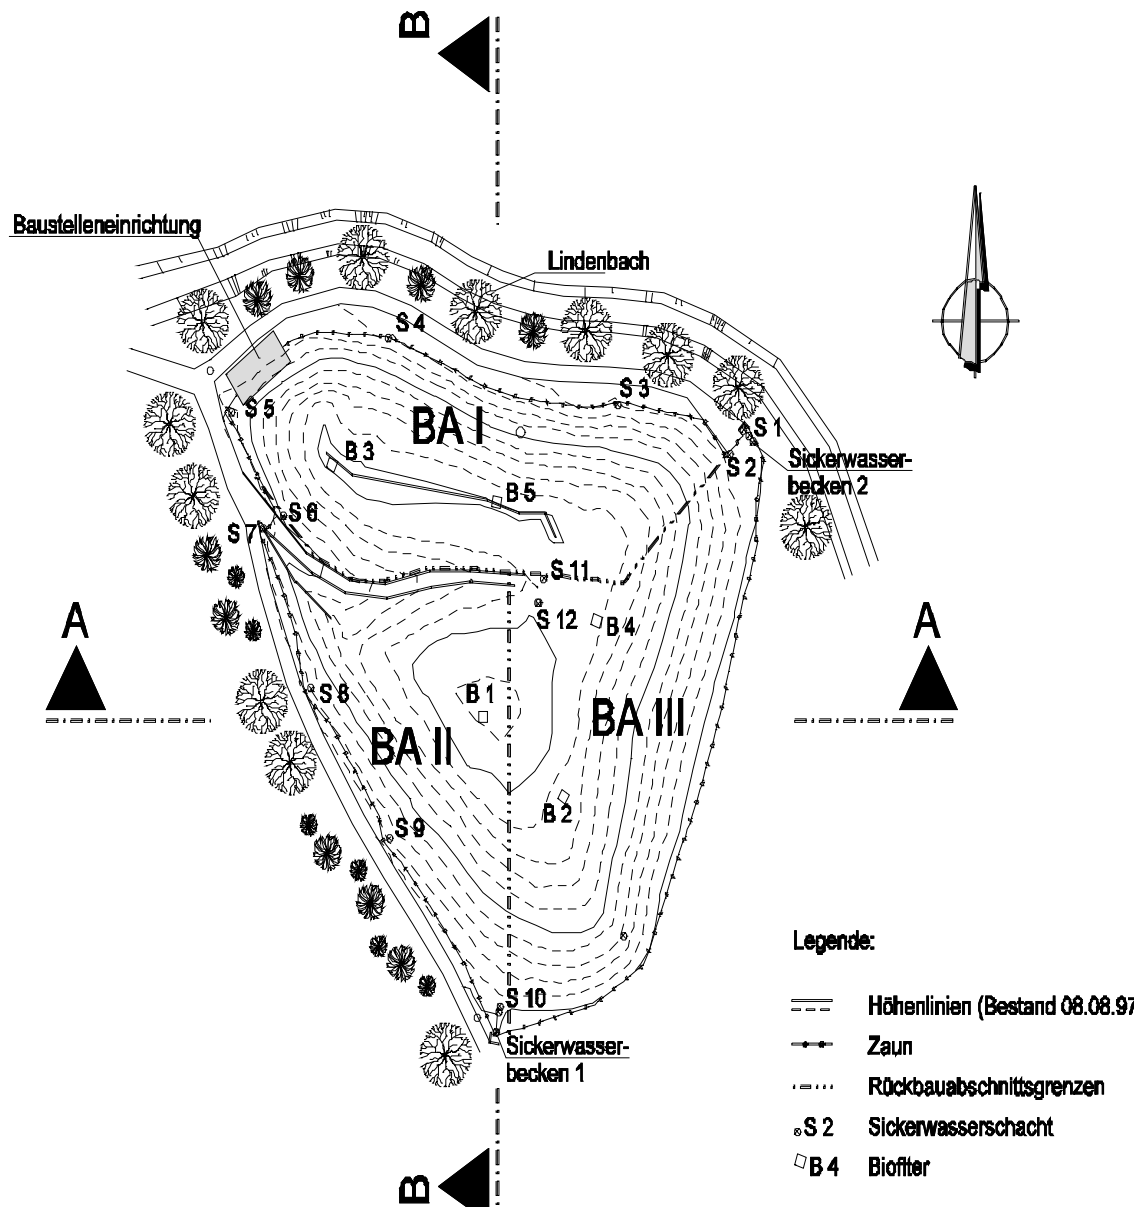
Lageplan mit der Bauabschnittsaufteilung
